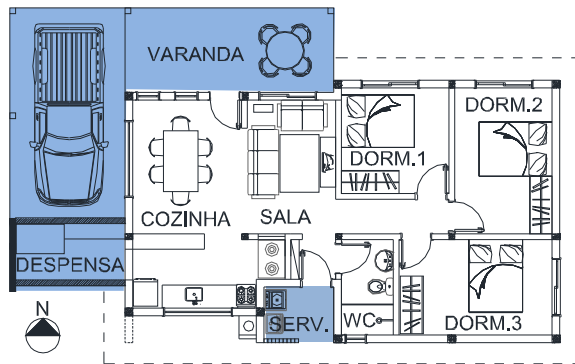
Planta baixa da casa proposta com ampliações por etapas (hachura azul)
